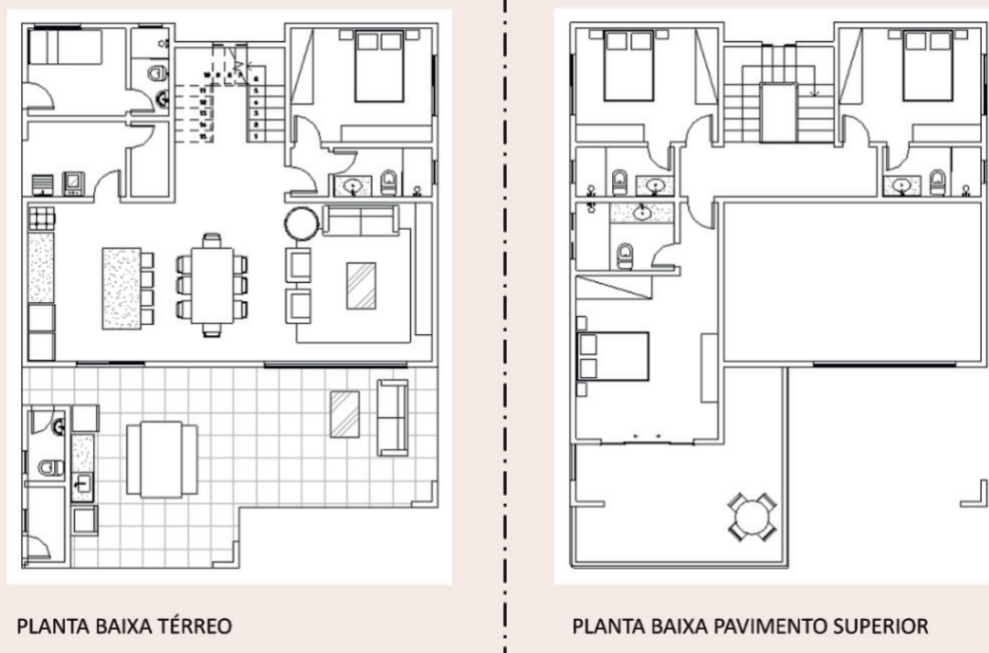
Planta baixa do térreo e pavimento superior da residência unifamiliar.
